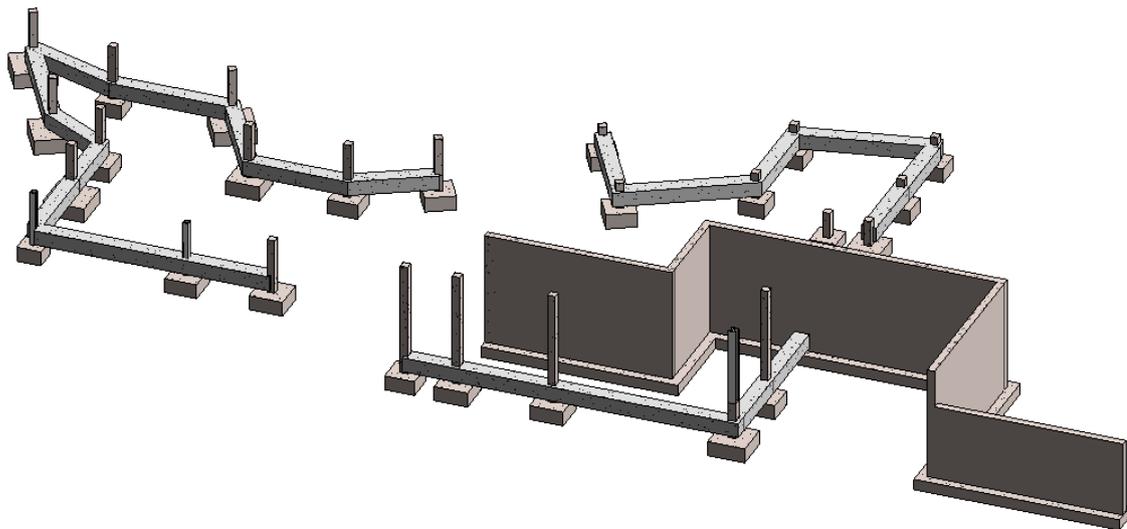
Modelo de estruturas com os elementos de fundação modelados
